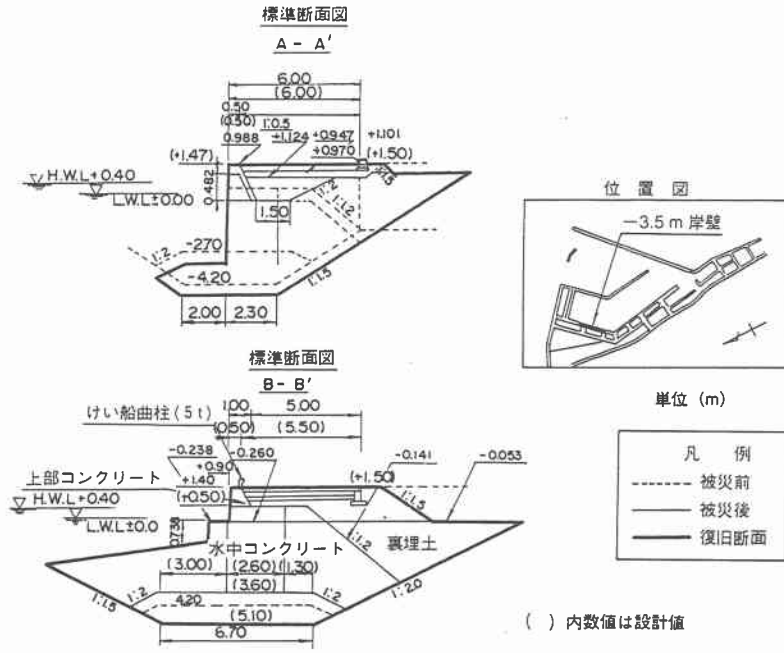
青苗漁港-3.5 m 岸壁被災断面図
